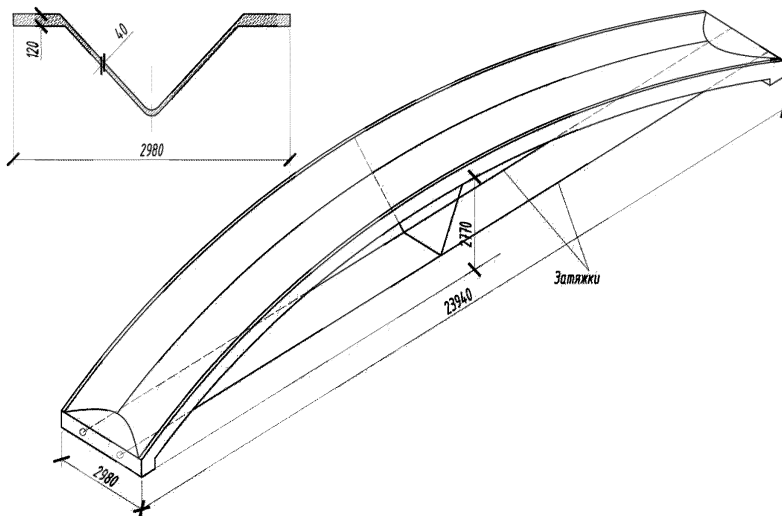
Арочная панель-складка (вверху – поперечный разрез)
